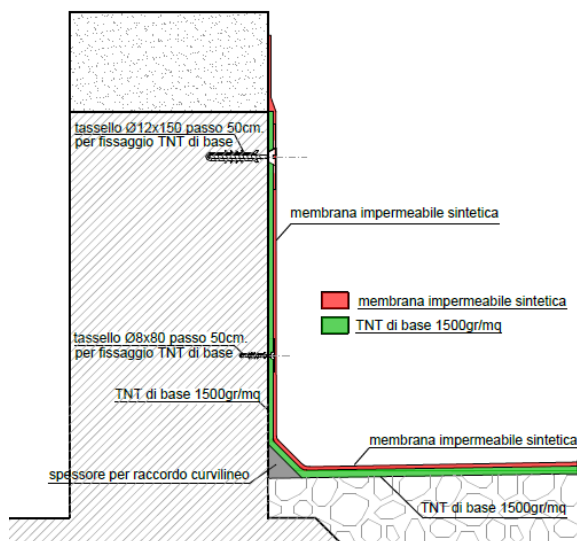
c - Rivestimento impermeabile (strato di colore rosso) sul parapetto/timpano
